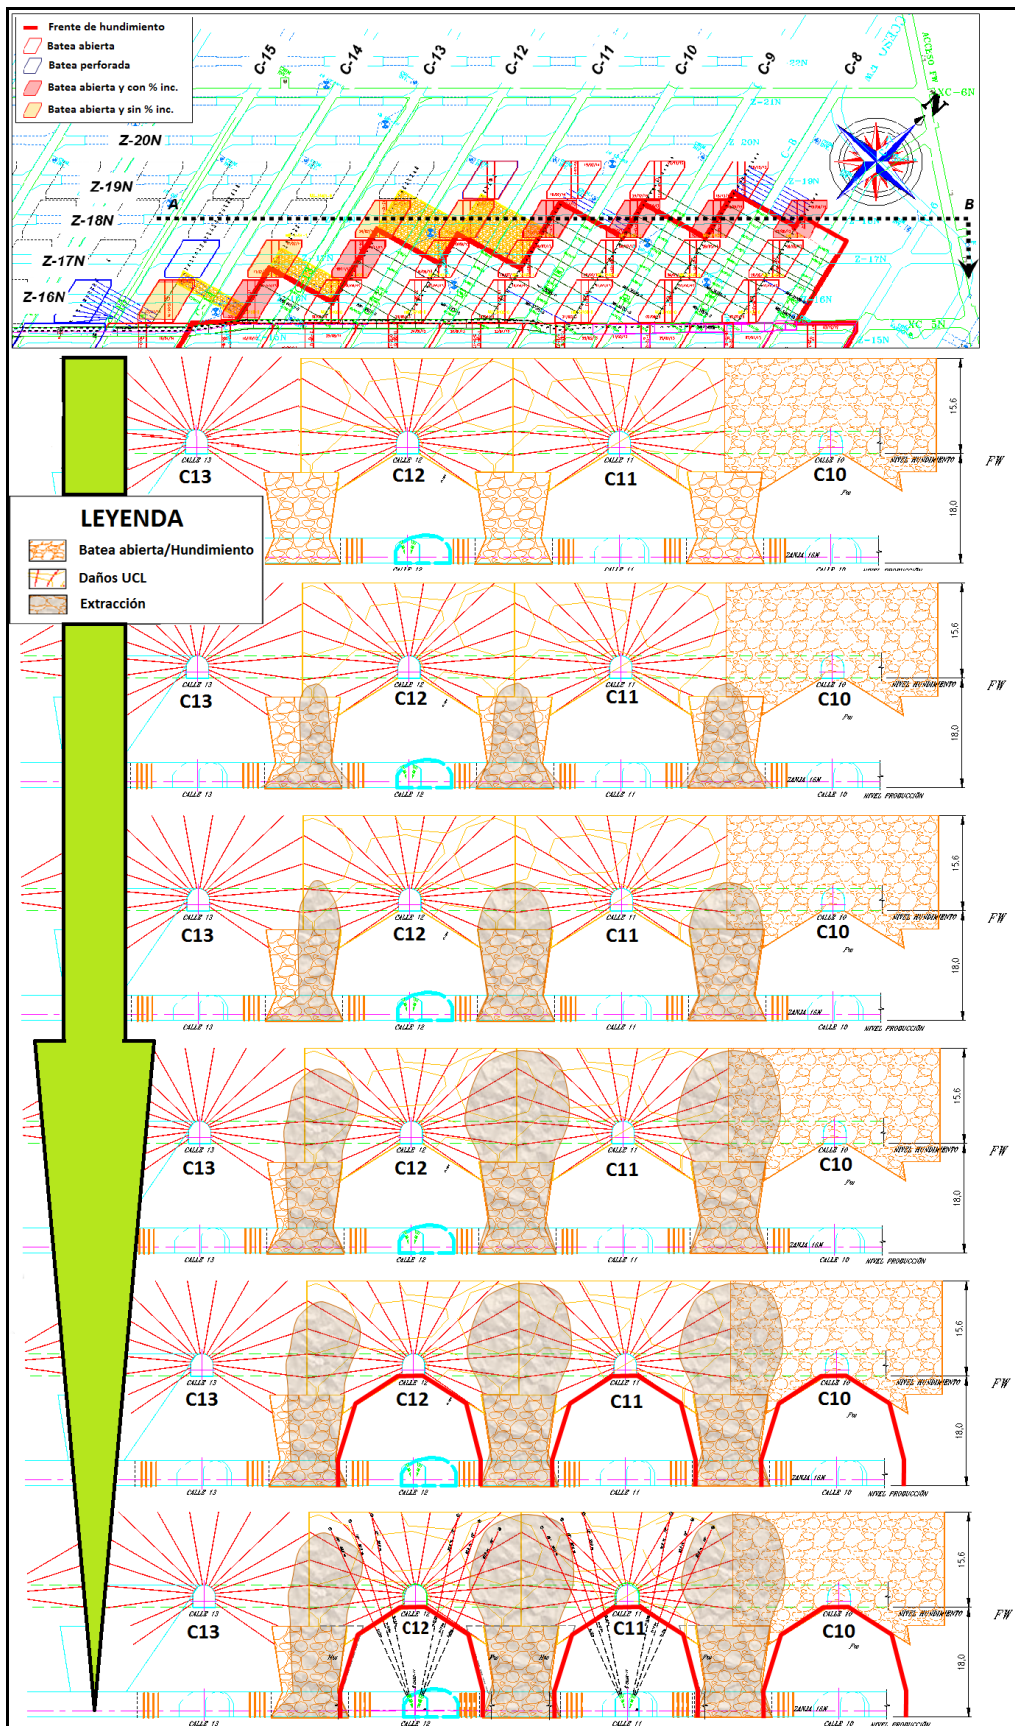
Esquema secuencia de extracción, vista en perfil Z18N (Superintendencia Mina Norte (c) 2014).
